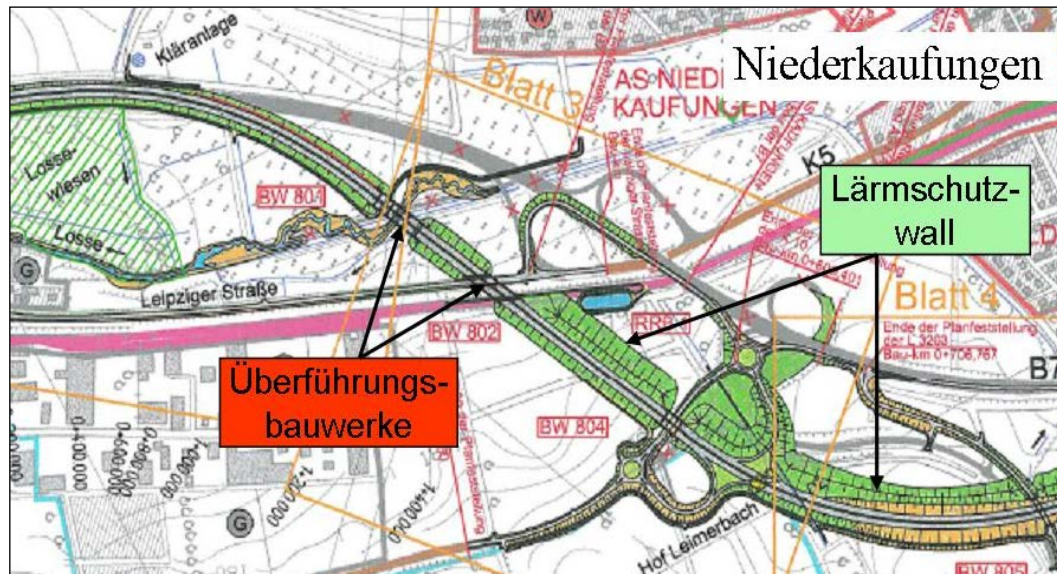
Lageplan BAB A 44 bei Niederkaufungen (Variantenuntersuchung 2010)
